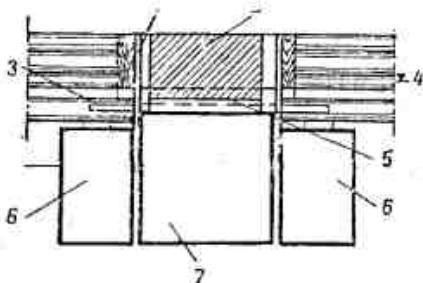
Фундамент под печь, устроенный на песчаной подсырке: 1—стена; 2—уровень пола верхнего этажа; 3—подошва фундамента; 4—фундамент под печь, бут; 5—угрибованный песок; 6—фундамент под стену, бут.
